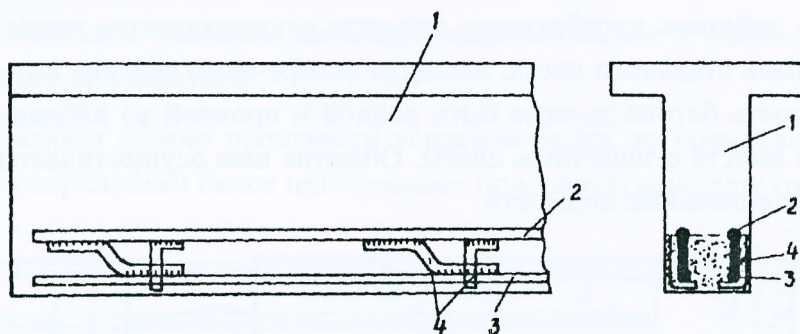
Усиление балок увеличением высоты сечения: 1 – балка; 2 – основная арматура; 3 – дополнительная арматура; 4 – вертикальные и наклонные элементы.
